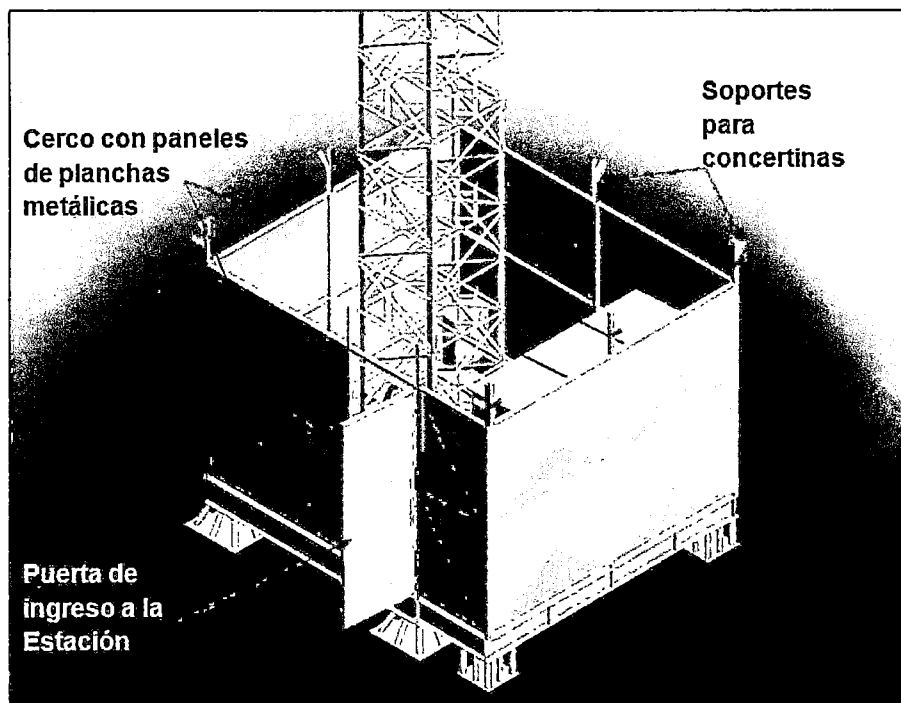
Cerco perimetral con paneles de planchas y perfiles metálicos.
